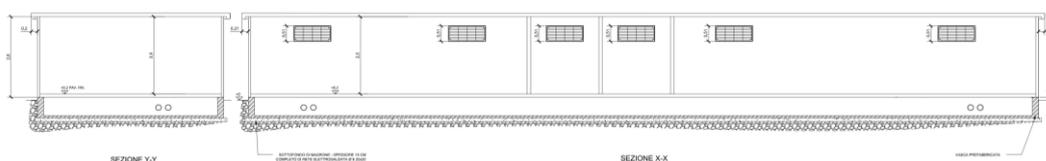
Cabina AT di smistamento - Vista in pianta e prospetto
